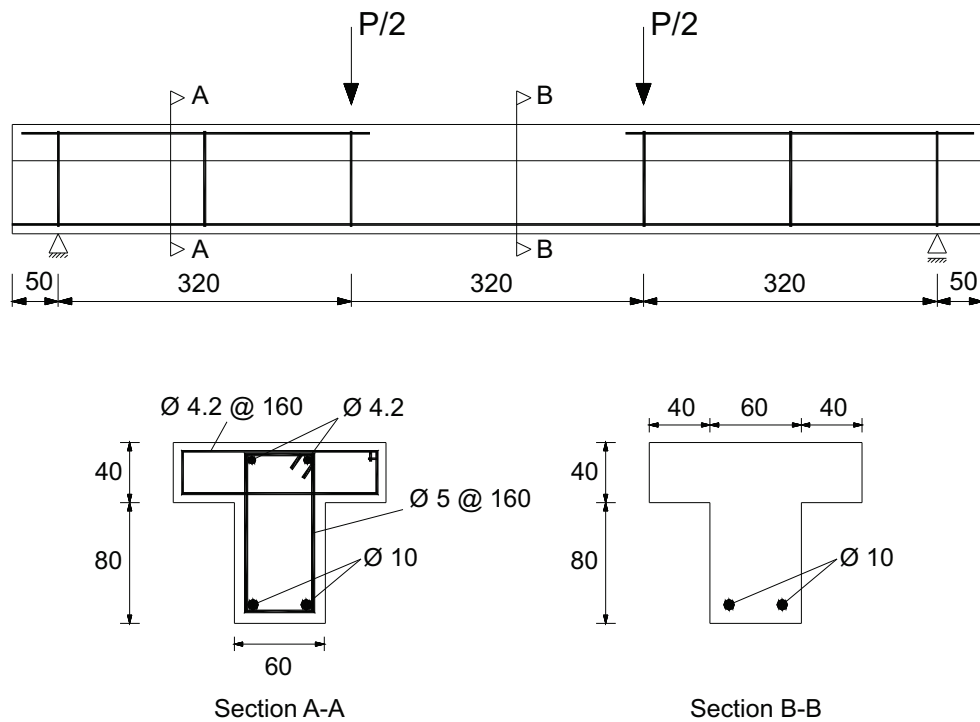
Esquema geral e detalhe das armaduras da viga VT-NA-SE-02 (dimensões em mm)
